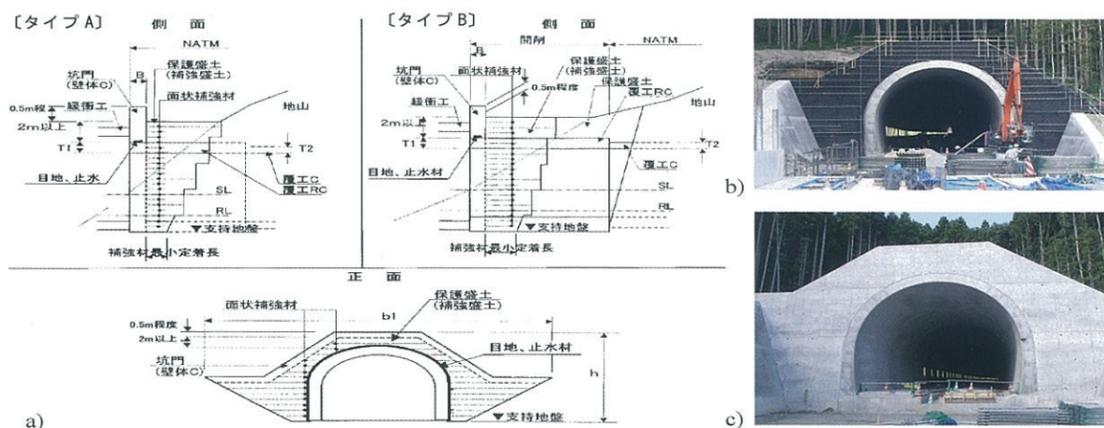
GRSトンネル坑門工: a) 2タイプ, b) 万太郎トンネル坑門部壁面の施工前, c) 施工後(図-2中の現場T10)
